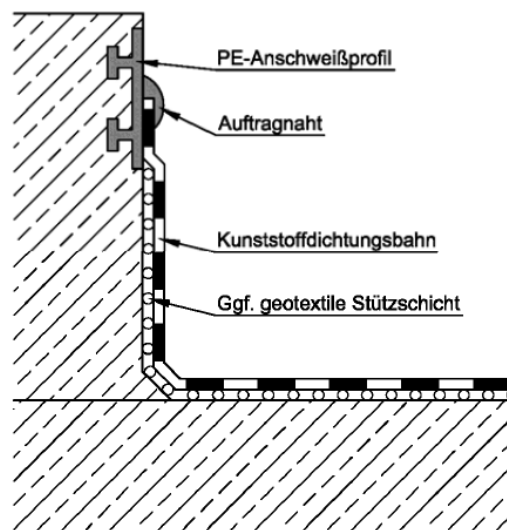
Anschluss einer KDB an eine Betonwand mittels eines einbetonierten Anschweißprofils⁵⁰
